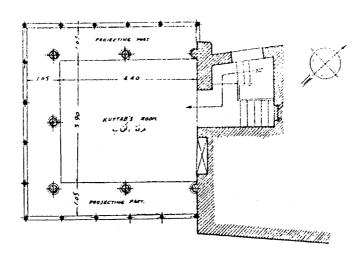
مسقط أفقي لسبيل السلطان الغوري الملحق بقبتة وخانقاته بالغورية (عن : لمعي) .
